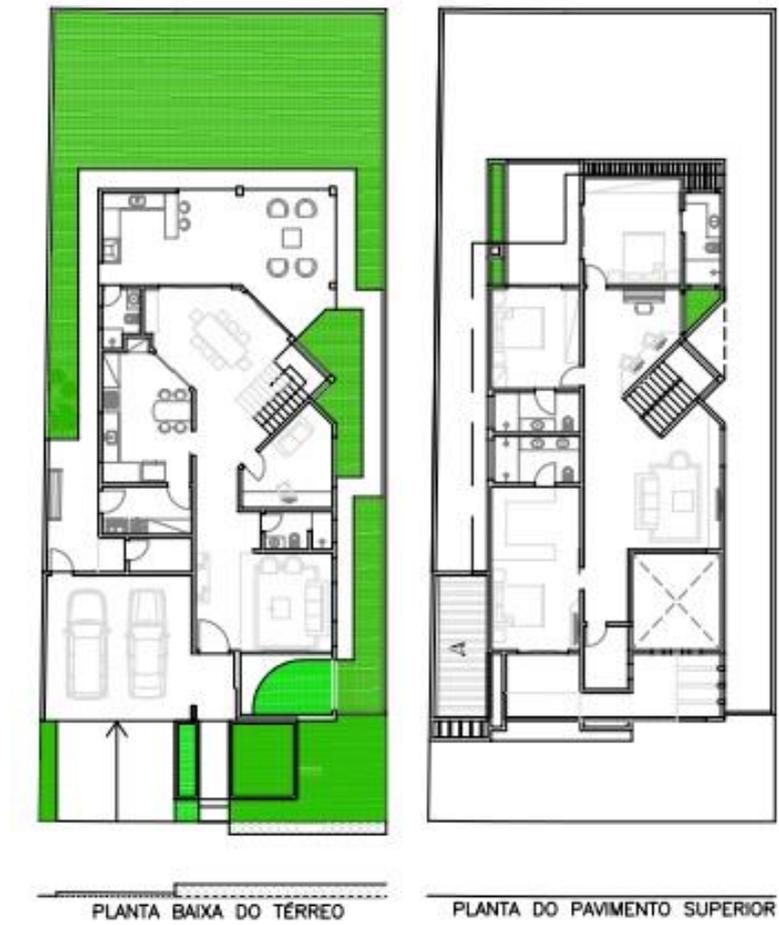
Planta baixa apresentada ao cliente (AP1- Ante projeto 1)
